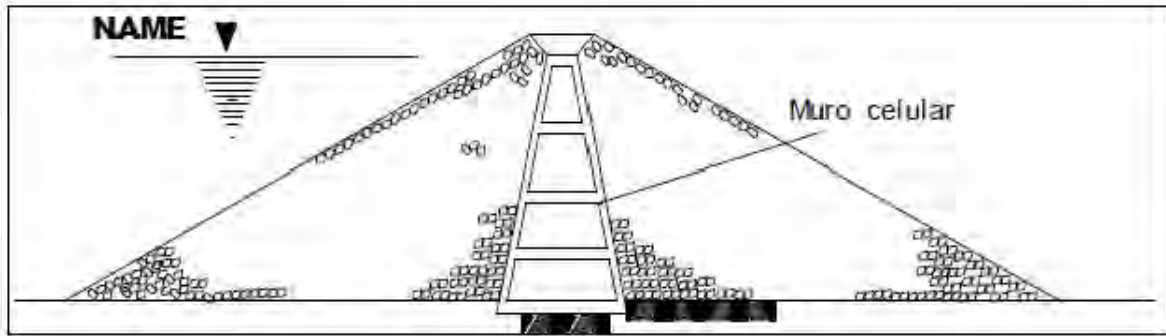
Presa de enrocamiento con muro celular (cimentación rígida)
